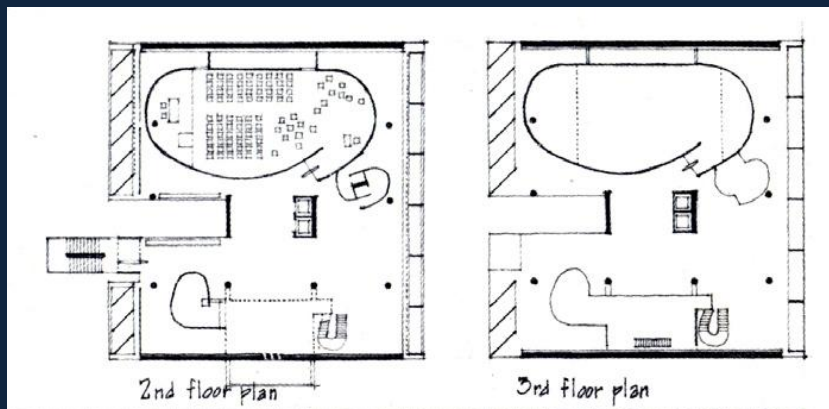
planta do 2º. pavimento e 3º. Pavimento Associação dos Moageiros, 1954 , Ahmedab , India
